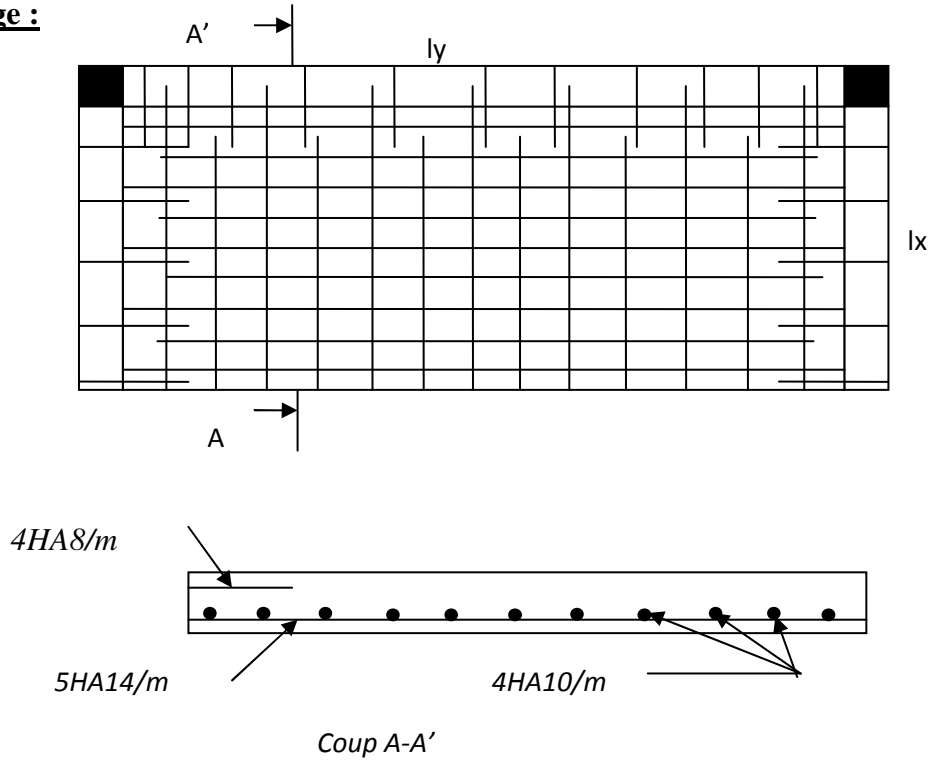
Schéma de ferrailage de la dalle pleine type3
